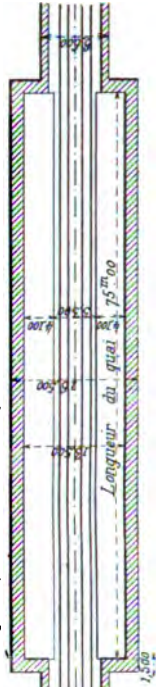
à 91. — Station avec plancher métallique sous chaussée.
